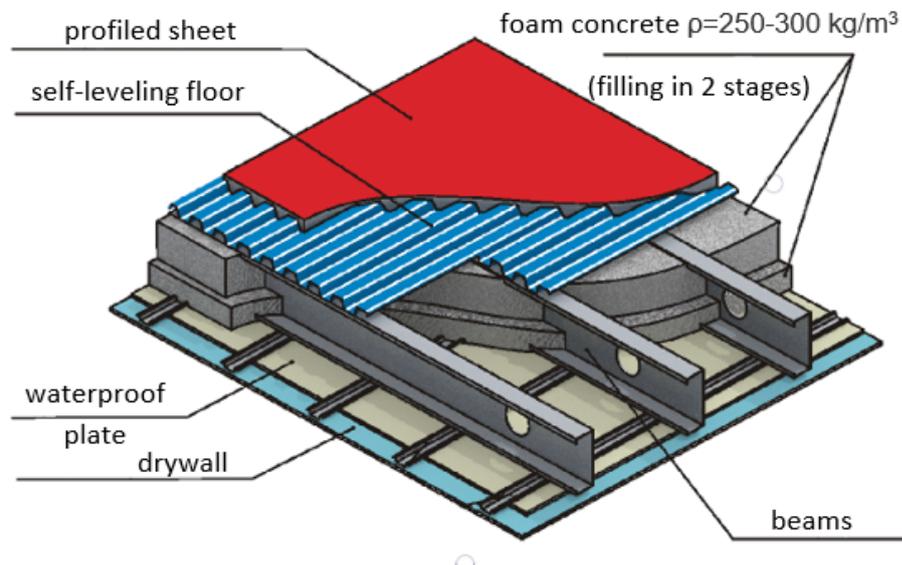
Конструкция перекрытия с жестким диском из профилированного листа [73]
